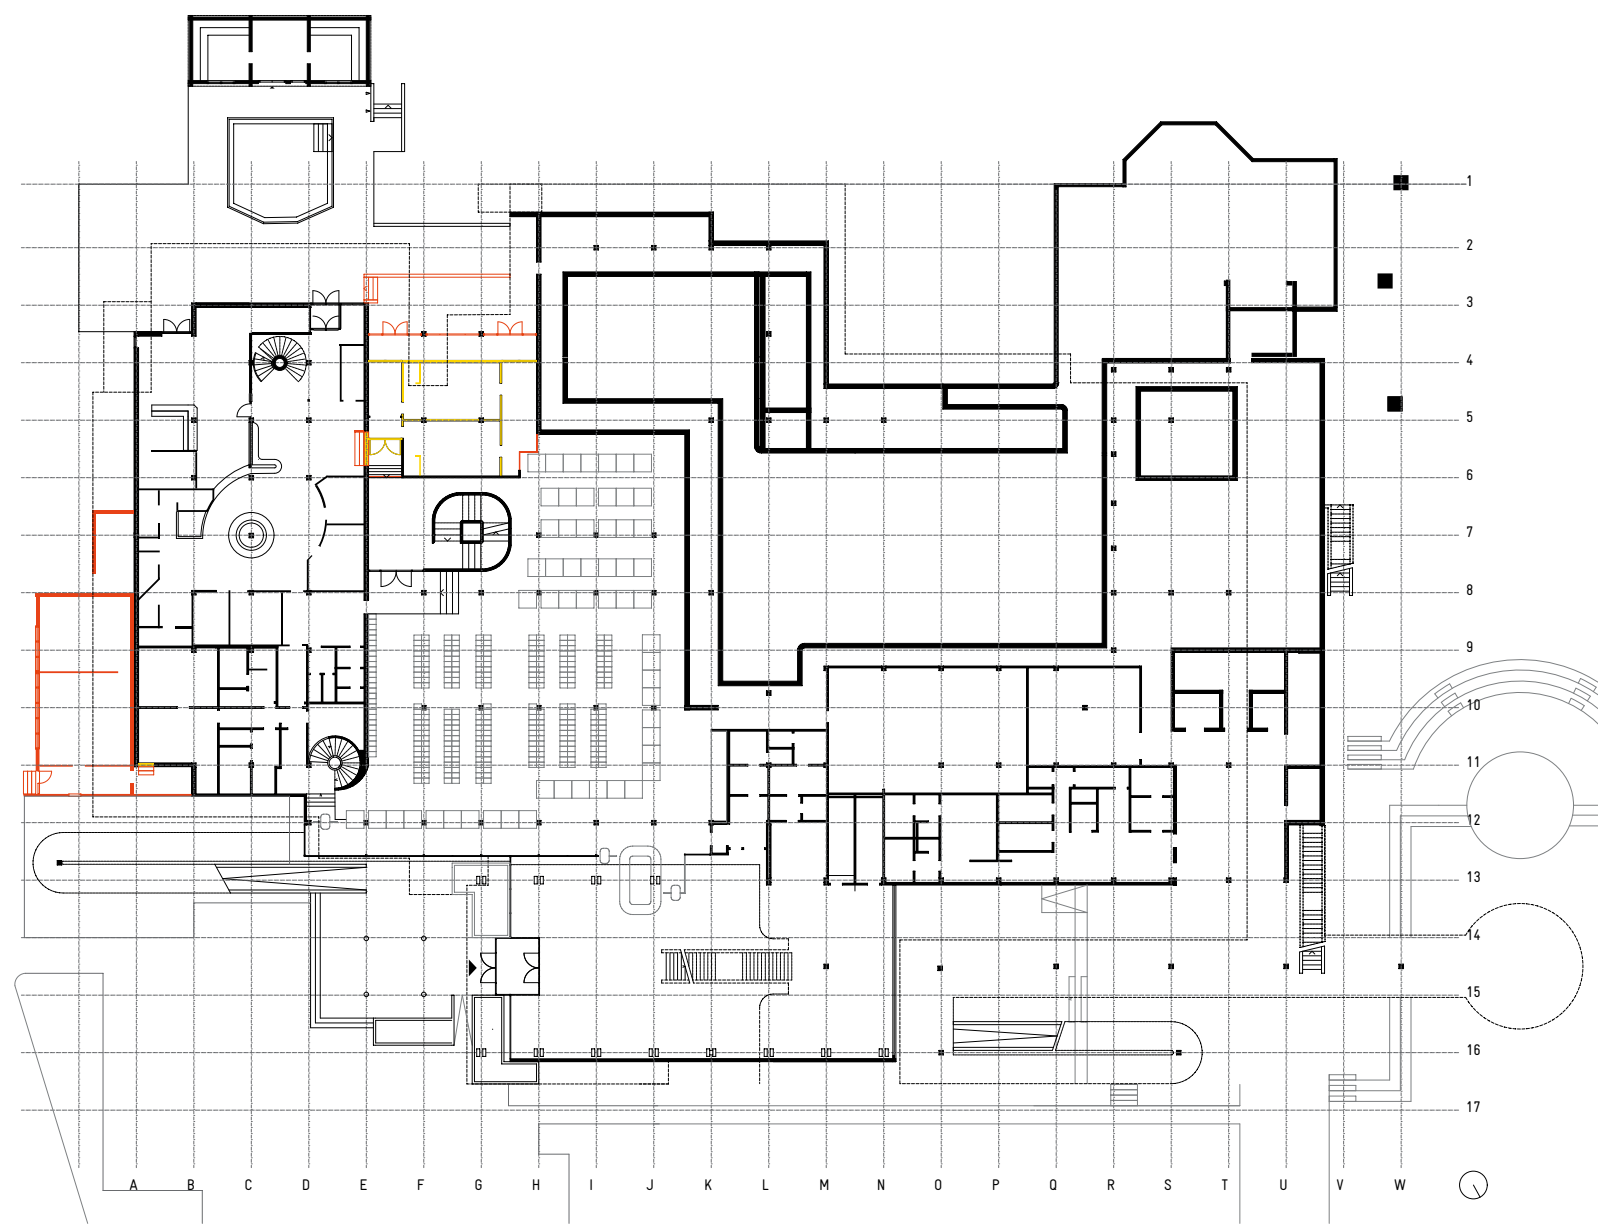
Erdgeschoß, Grundriss 1-500 inkl. Zubau Büro und Umbau Schülergarderoben
